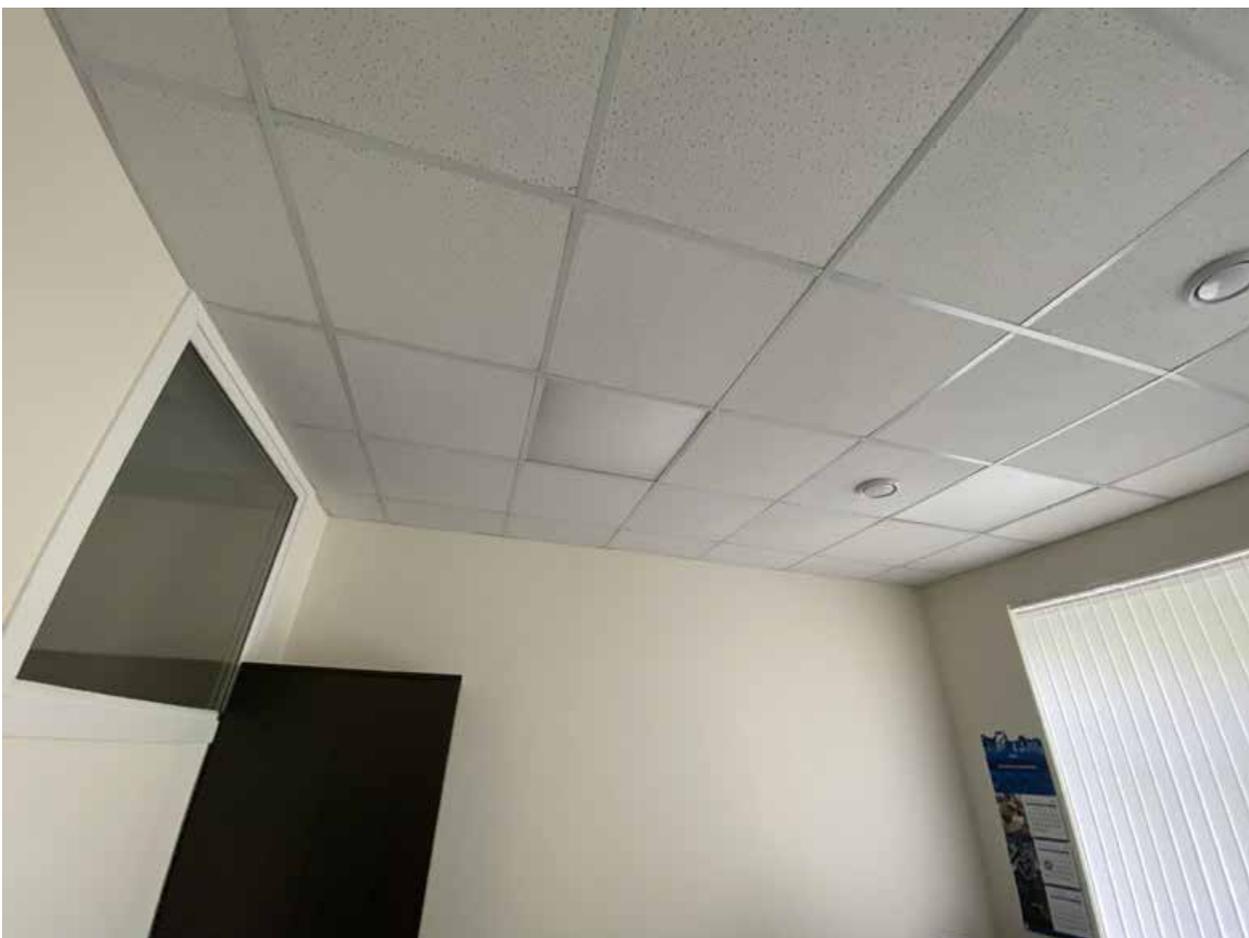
3 этаж. Помещение 6-Н(6-10).
